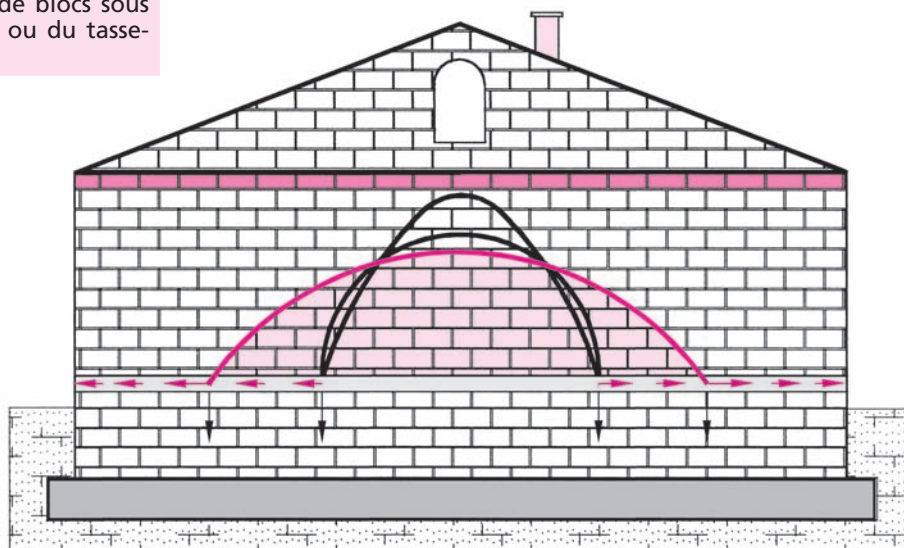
Mur de façade d'un pavillon sur vide sanitaire
